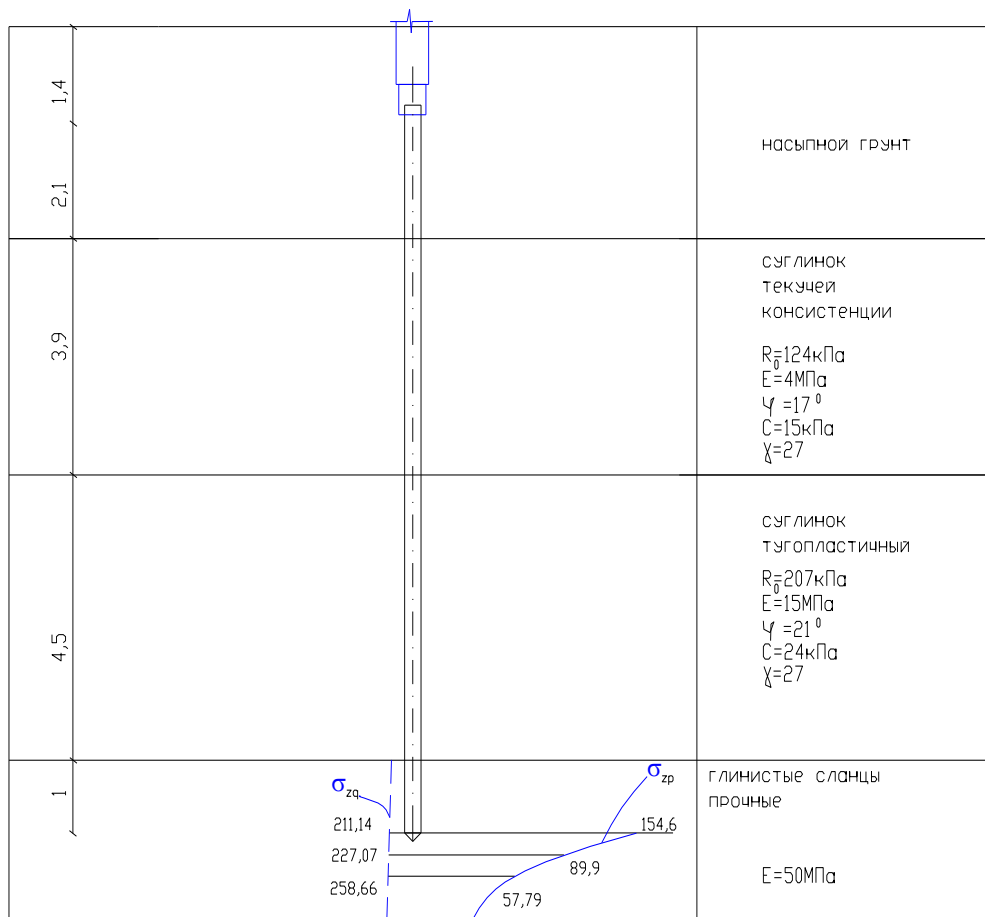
Схема до розрахунку осідання стрічкового фундаменту палі
